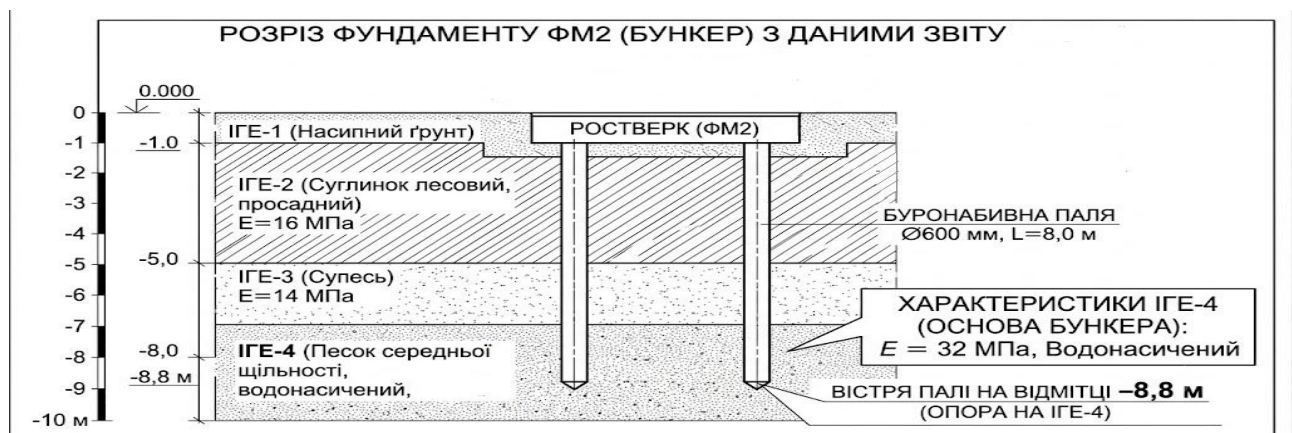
Розріз фундаменту ФМ2 з даними звіту
